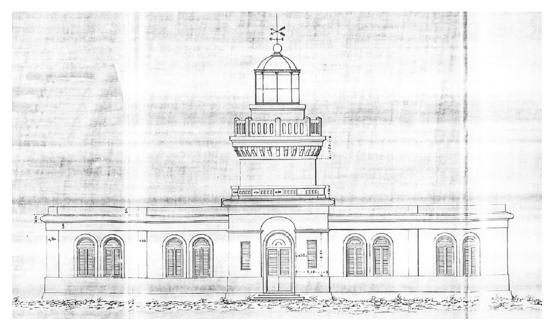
«Fachada anterior Hoja 3ª Planos Generales y de Detalle del edificio y torre del faro de 3e órden de las Cabezas de S. Juan». (SGPR, 1876)
